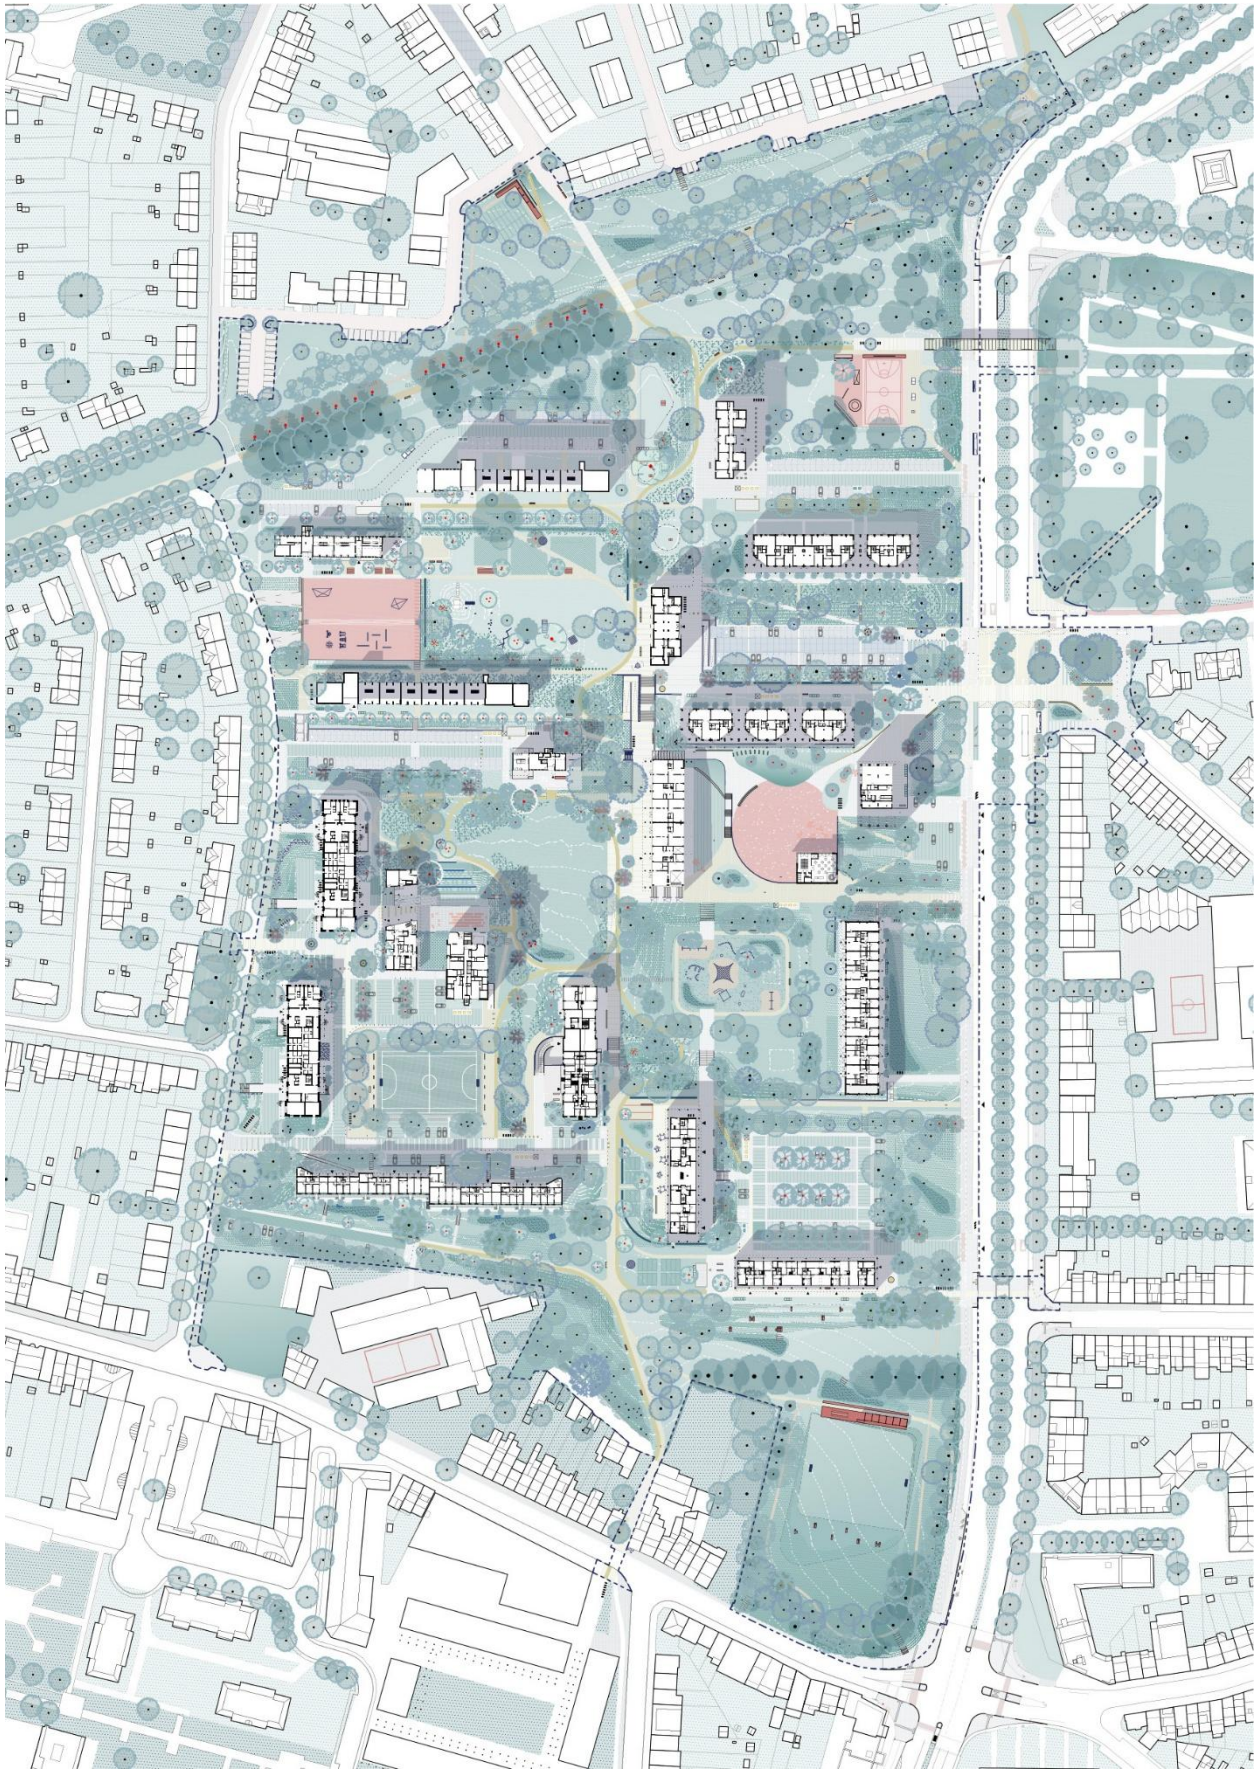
Studio Paola Vigano, *Plan d'aménagement*, s.d., plan, Paola Vigano.
